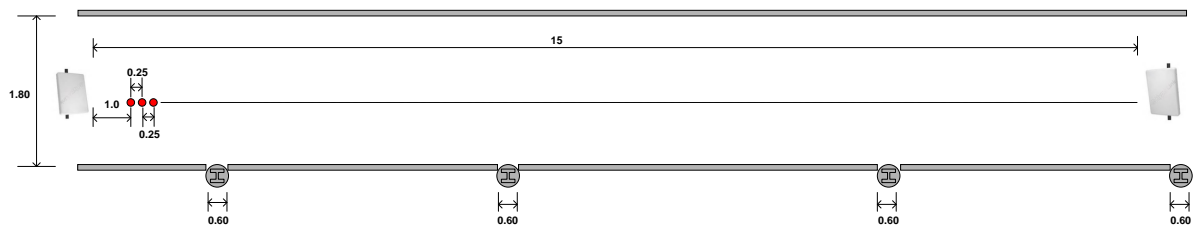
Plano del pasillo junto a los despachos C104 - C112, Planta 1, Edificio C
